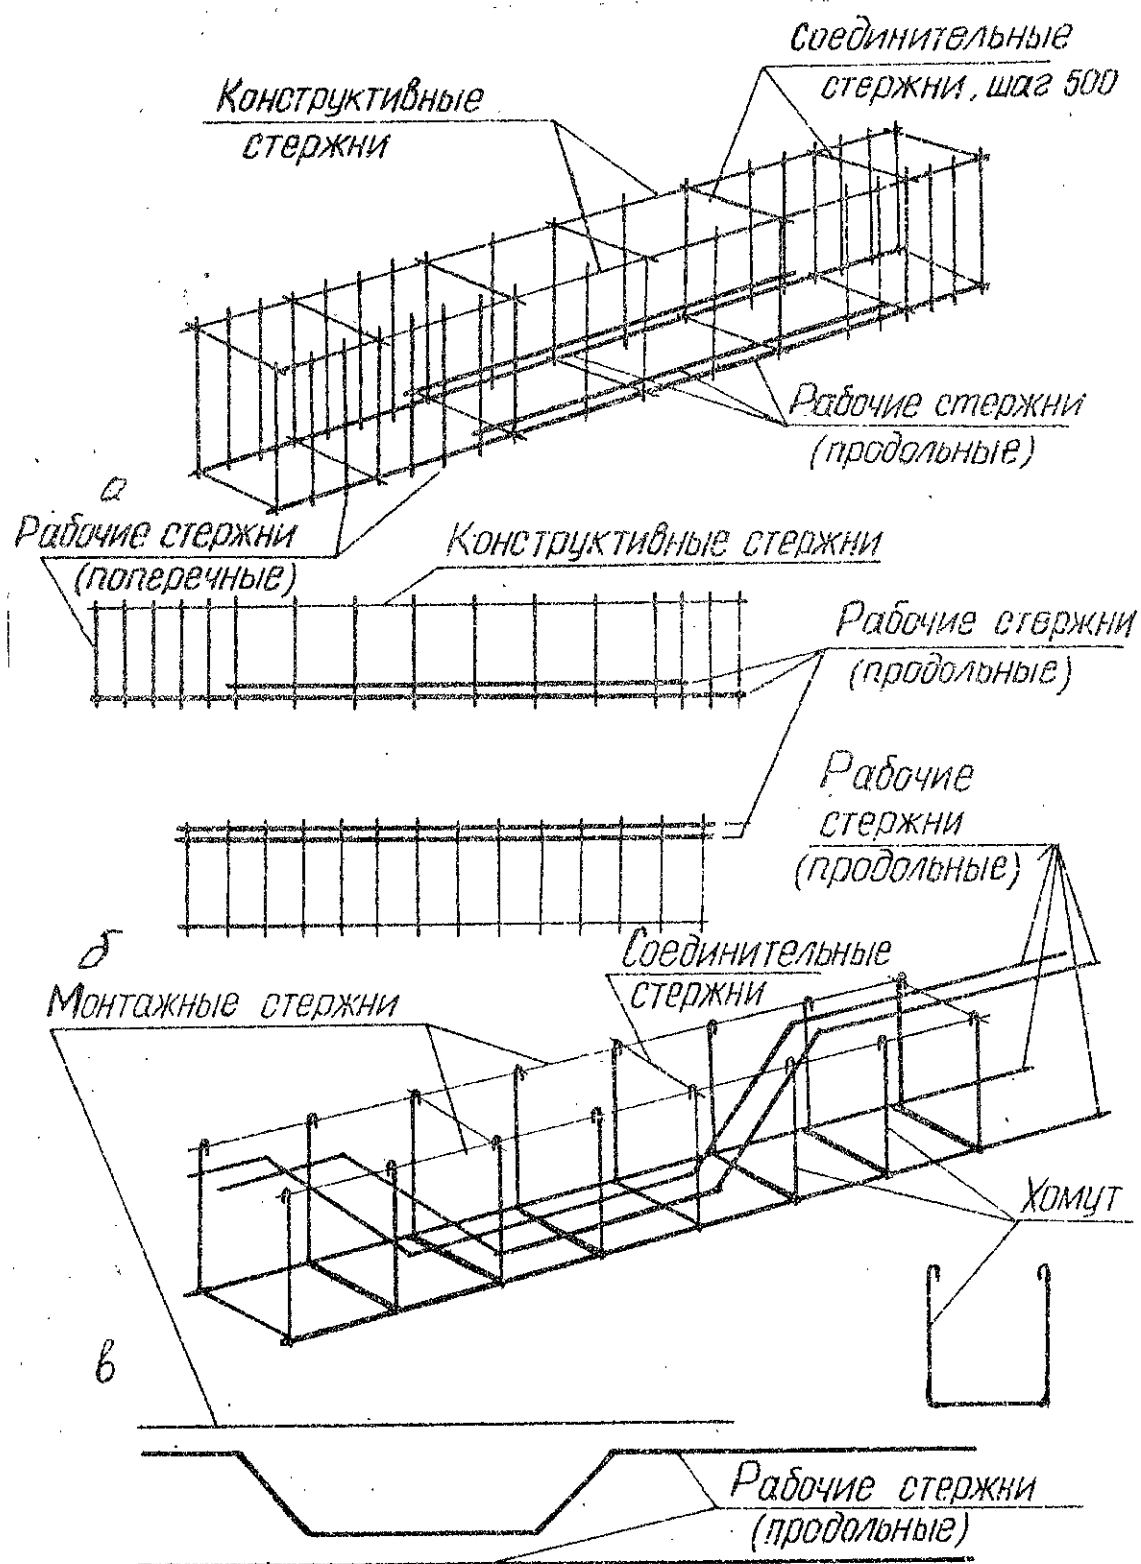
Каркасы: а - сварной пространственный; б - сварные плоские; в - вязаный пространственный из отдельных стержней; г - отдельные продольные стержни
